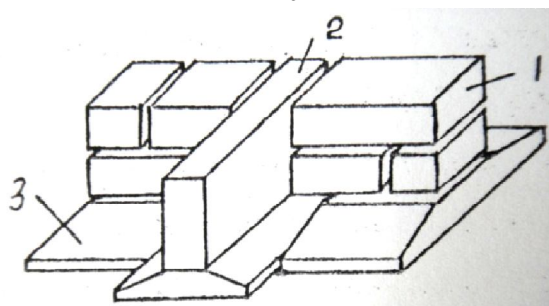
Схема монтажа блоков ленточных фундаментов
